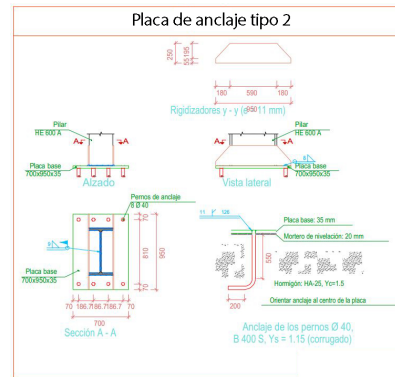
Aquí se muestra la placa de anclaje tipo 2 que corresponde al anclaje de los pilares de los pórticos interiores con la cimentación y es la más común. Se pueden observar con detalle los demás tipos de placas en el anexo de planos.
